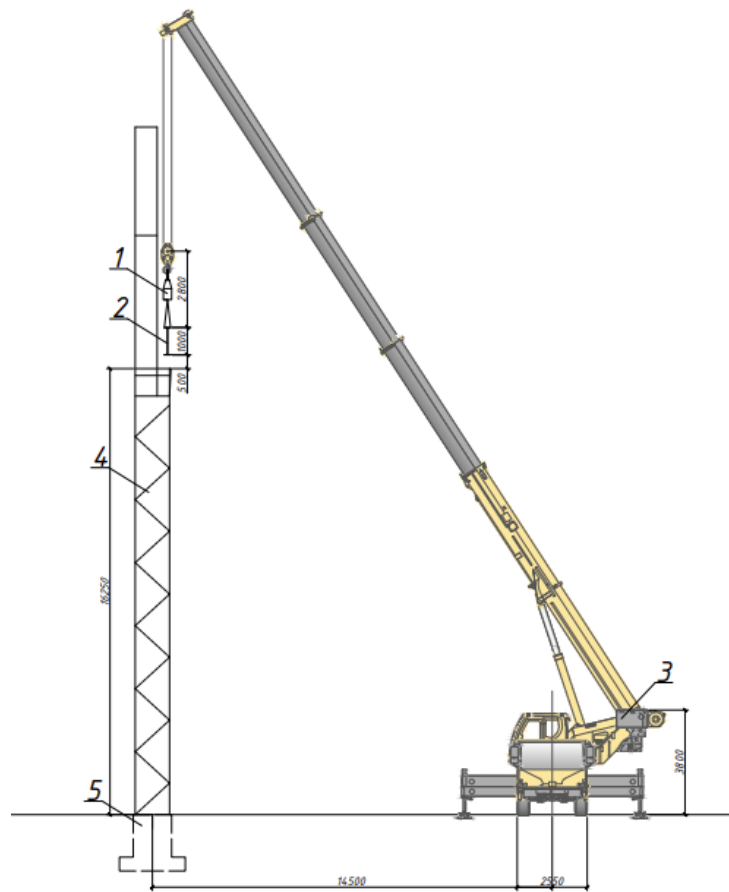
Монтаж підкранової балки (1 – траверса; 2 – підкранова балка; 3 – автокран; 4 – змонтована колона; 5 – фундамент).
